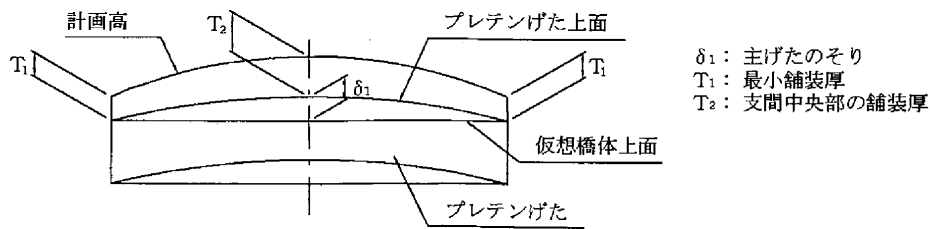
舗装面が凸の場合で、桁の曲率>舗装面の曲率の場合
